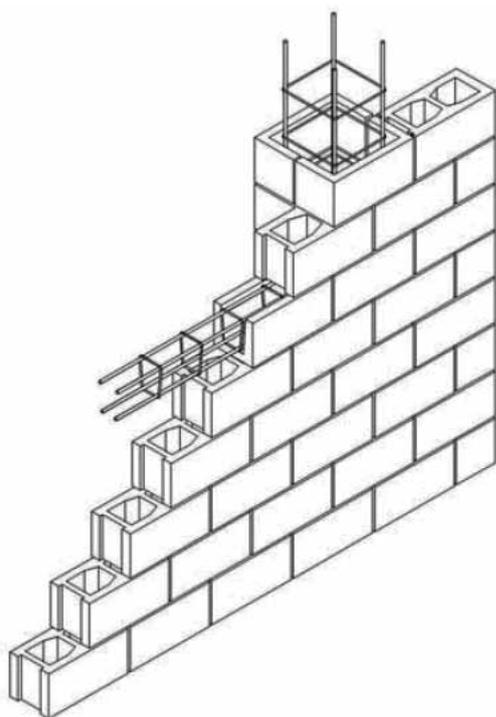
Muro con piezas especiales para pilastra sobresaliente de hormigón armado.
